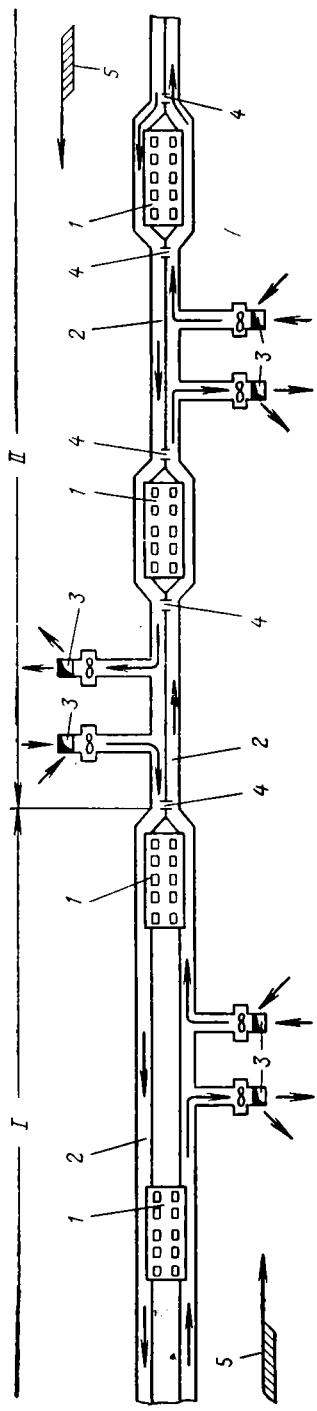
III. Схема системы вентиляции искусственного побуждения № 8 с двумя вентиляционными установками и шахтами на перегоне:
